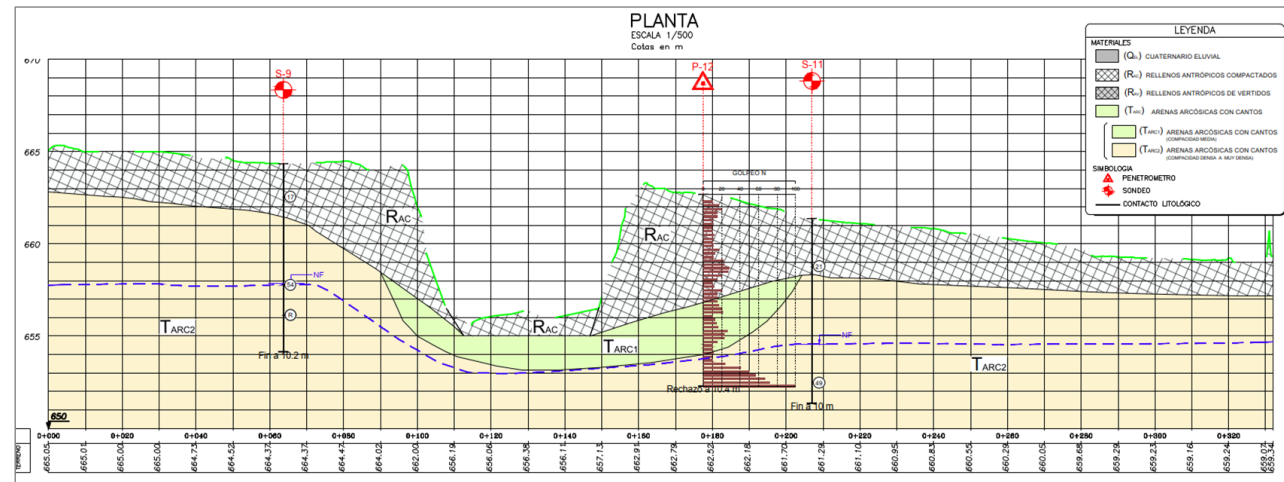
Perfil longitudinal Pantalla A1-16-MI-1
